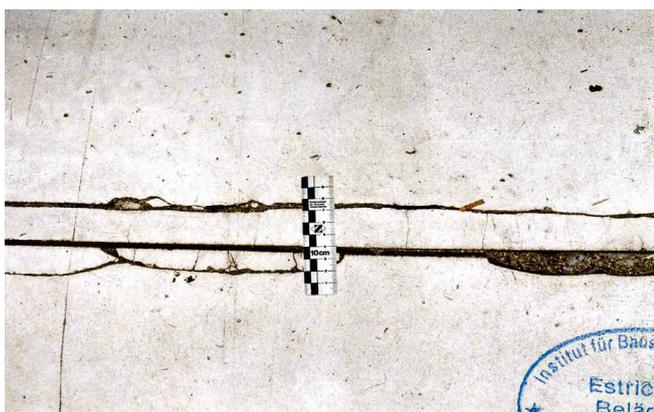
Riss über einer Arbeitsfuge neben einer nicht deckungsgleich eingeschnittenen Estrichfuge
